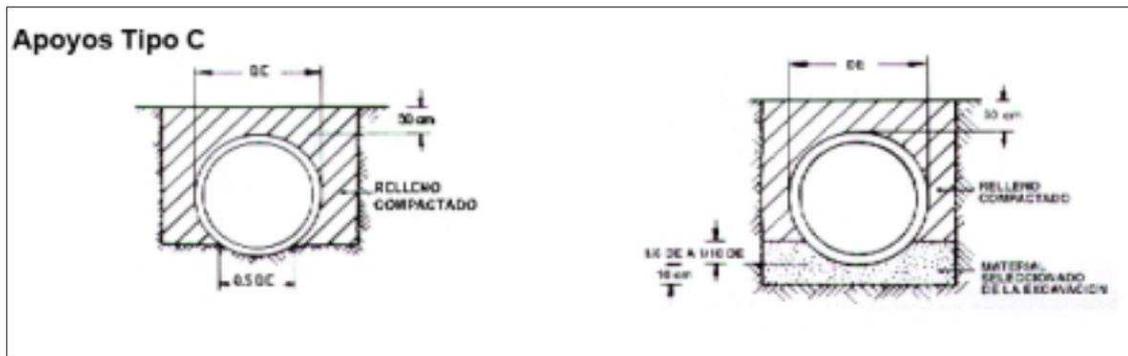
Cama de apoyo, apropiadas para tuberías de PVC.
